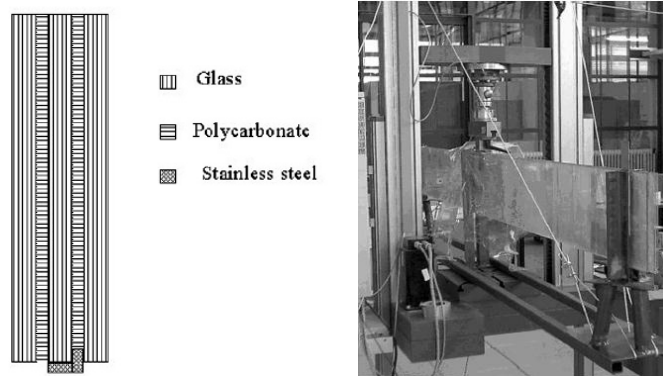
Secção transversal da viga de vidro reforçada e setup do ensaio (F.A.Veer et al, 2003).
